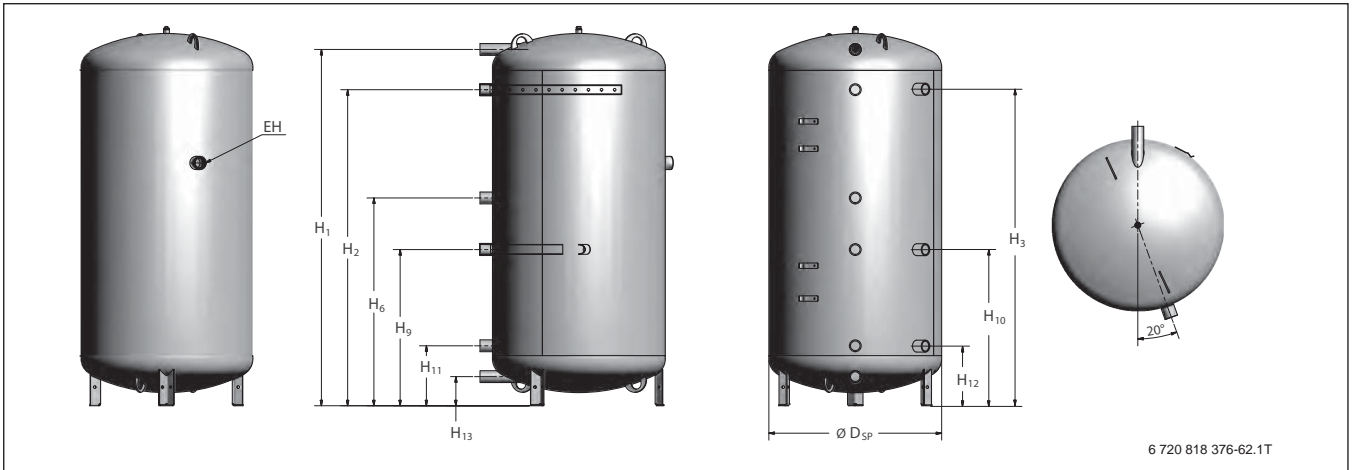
Anschlüsse mit Abmessungen PRZ500/750/1000.6 EW (Darstellung ohne Wärmedämmung)
